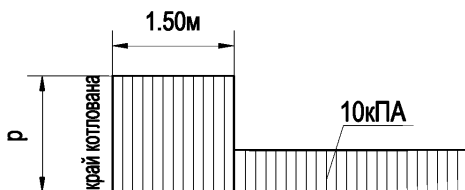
Вертикальная нагрузка на призме обрушения от гусеничных и колесных кранов
